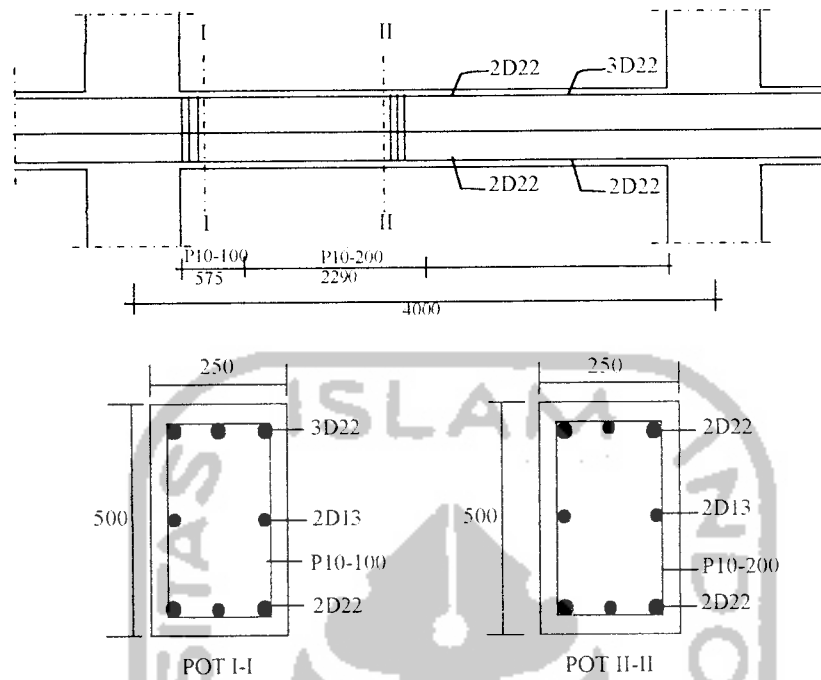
Balok Portal E Bentang 4 m Lantai 7
